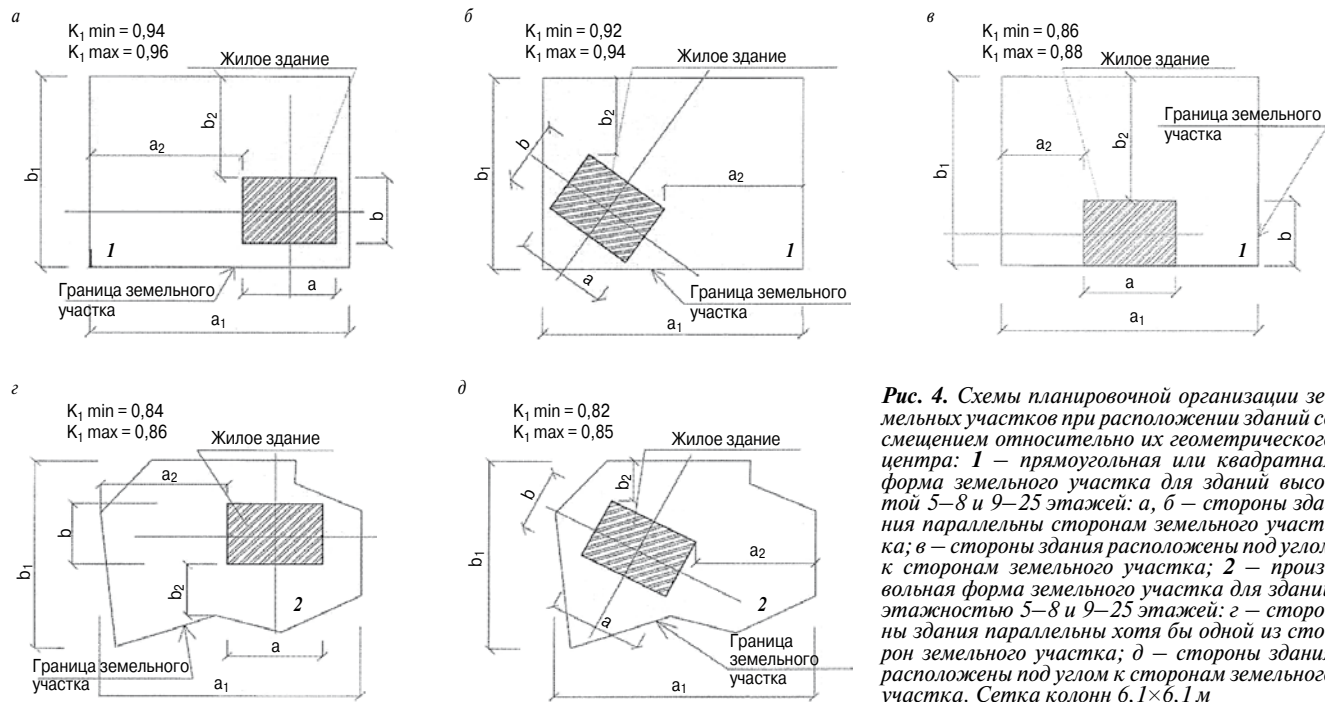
Схемы планировочной организации земельных участков при расположении зданий со смещением относительно их геометрического центра: 1 – прямоугольная или квадратная форма земельного участка для зданий высотой 5–8 и 9–25 этажей; а, б – стороны здания параллельны сторонам земельного участка; в – стороны здания расположены под углом к сторонам земельного участка; 2 – произвольная форма земельного участка для зданий этажностью 5–8 и 9–25 этажей; г – стороны здания параллельны хотя бы одной из сторон земельного участка; д – стороны здания расположены под углом к сторонам земельного участка. Сетка колонн 6,1×6,1 м
